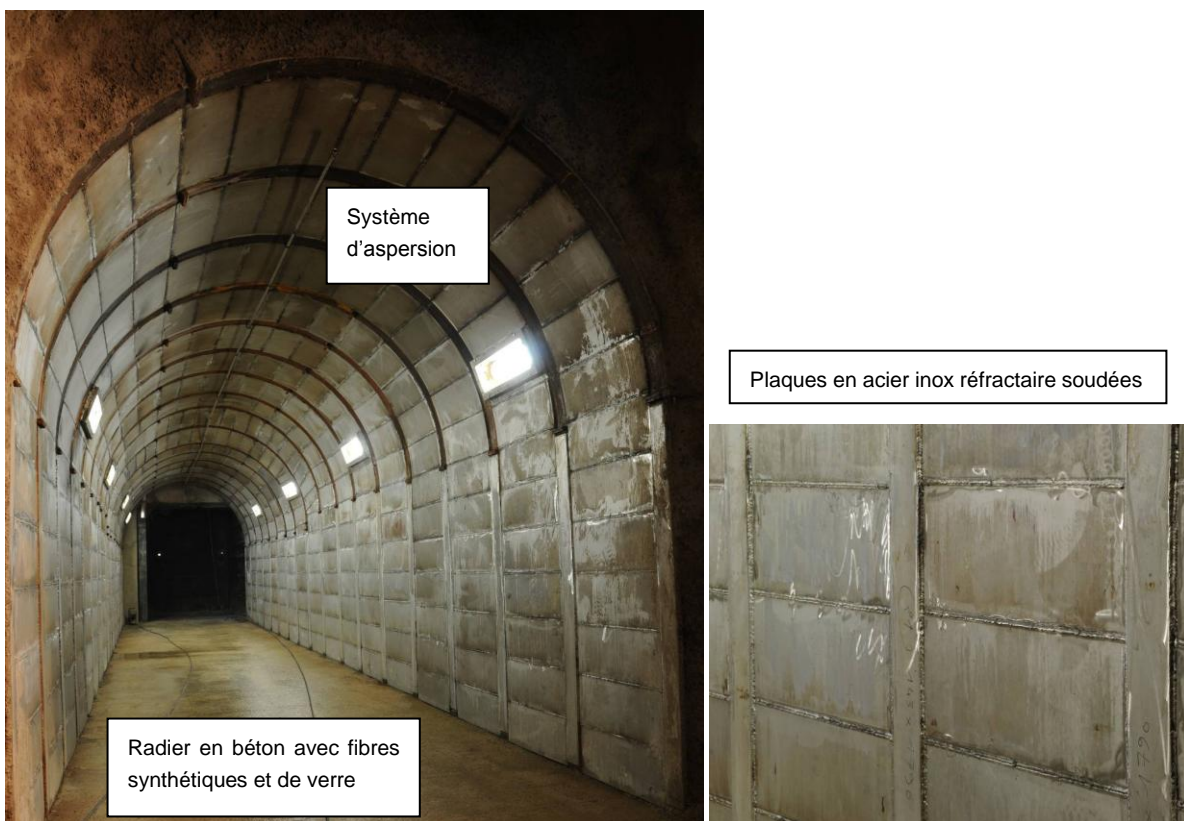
Vue de la zone d'essais renforcée par plaques d'acier
